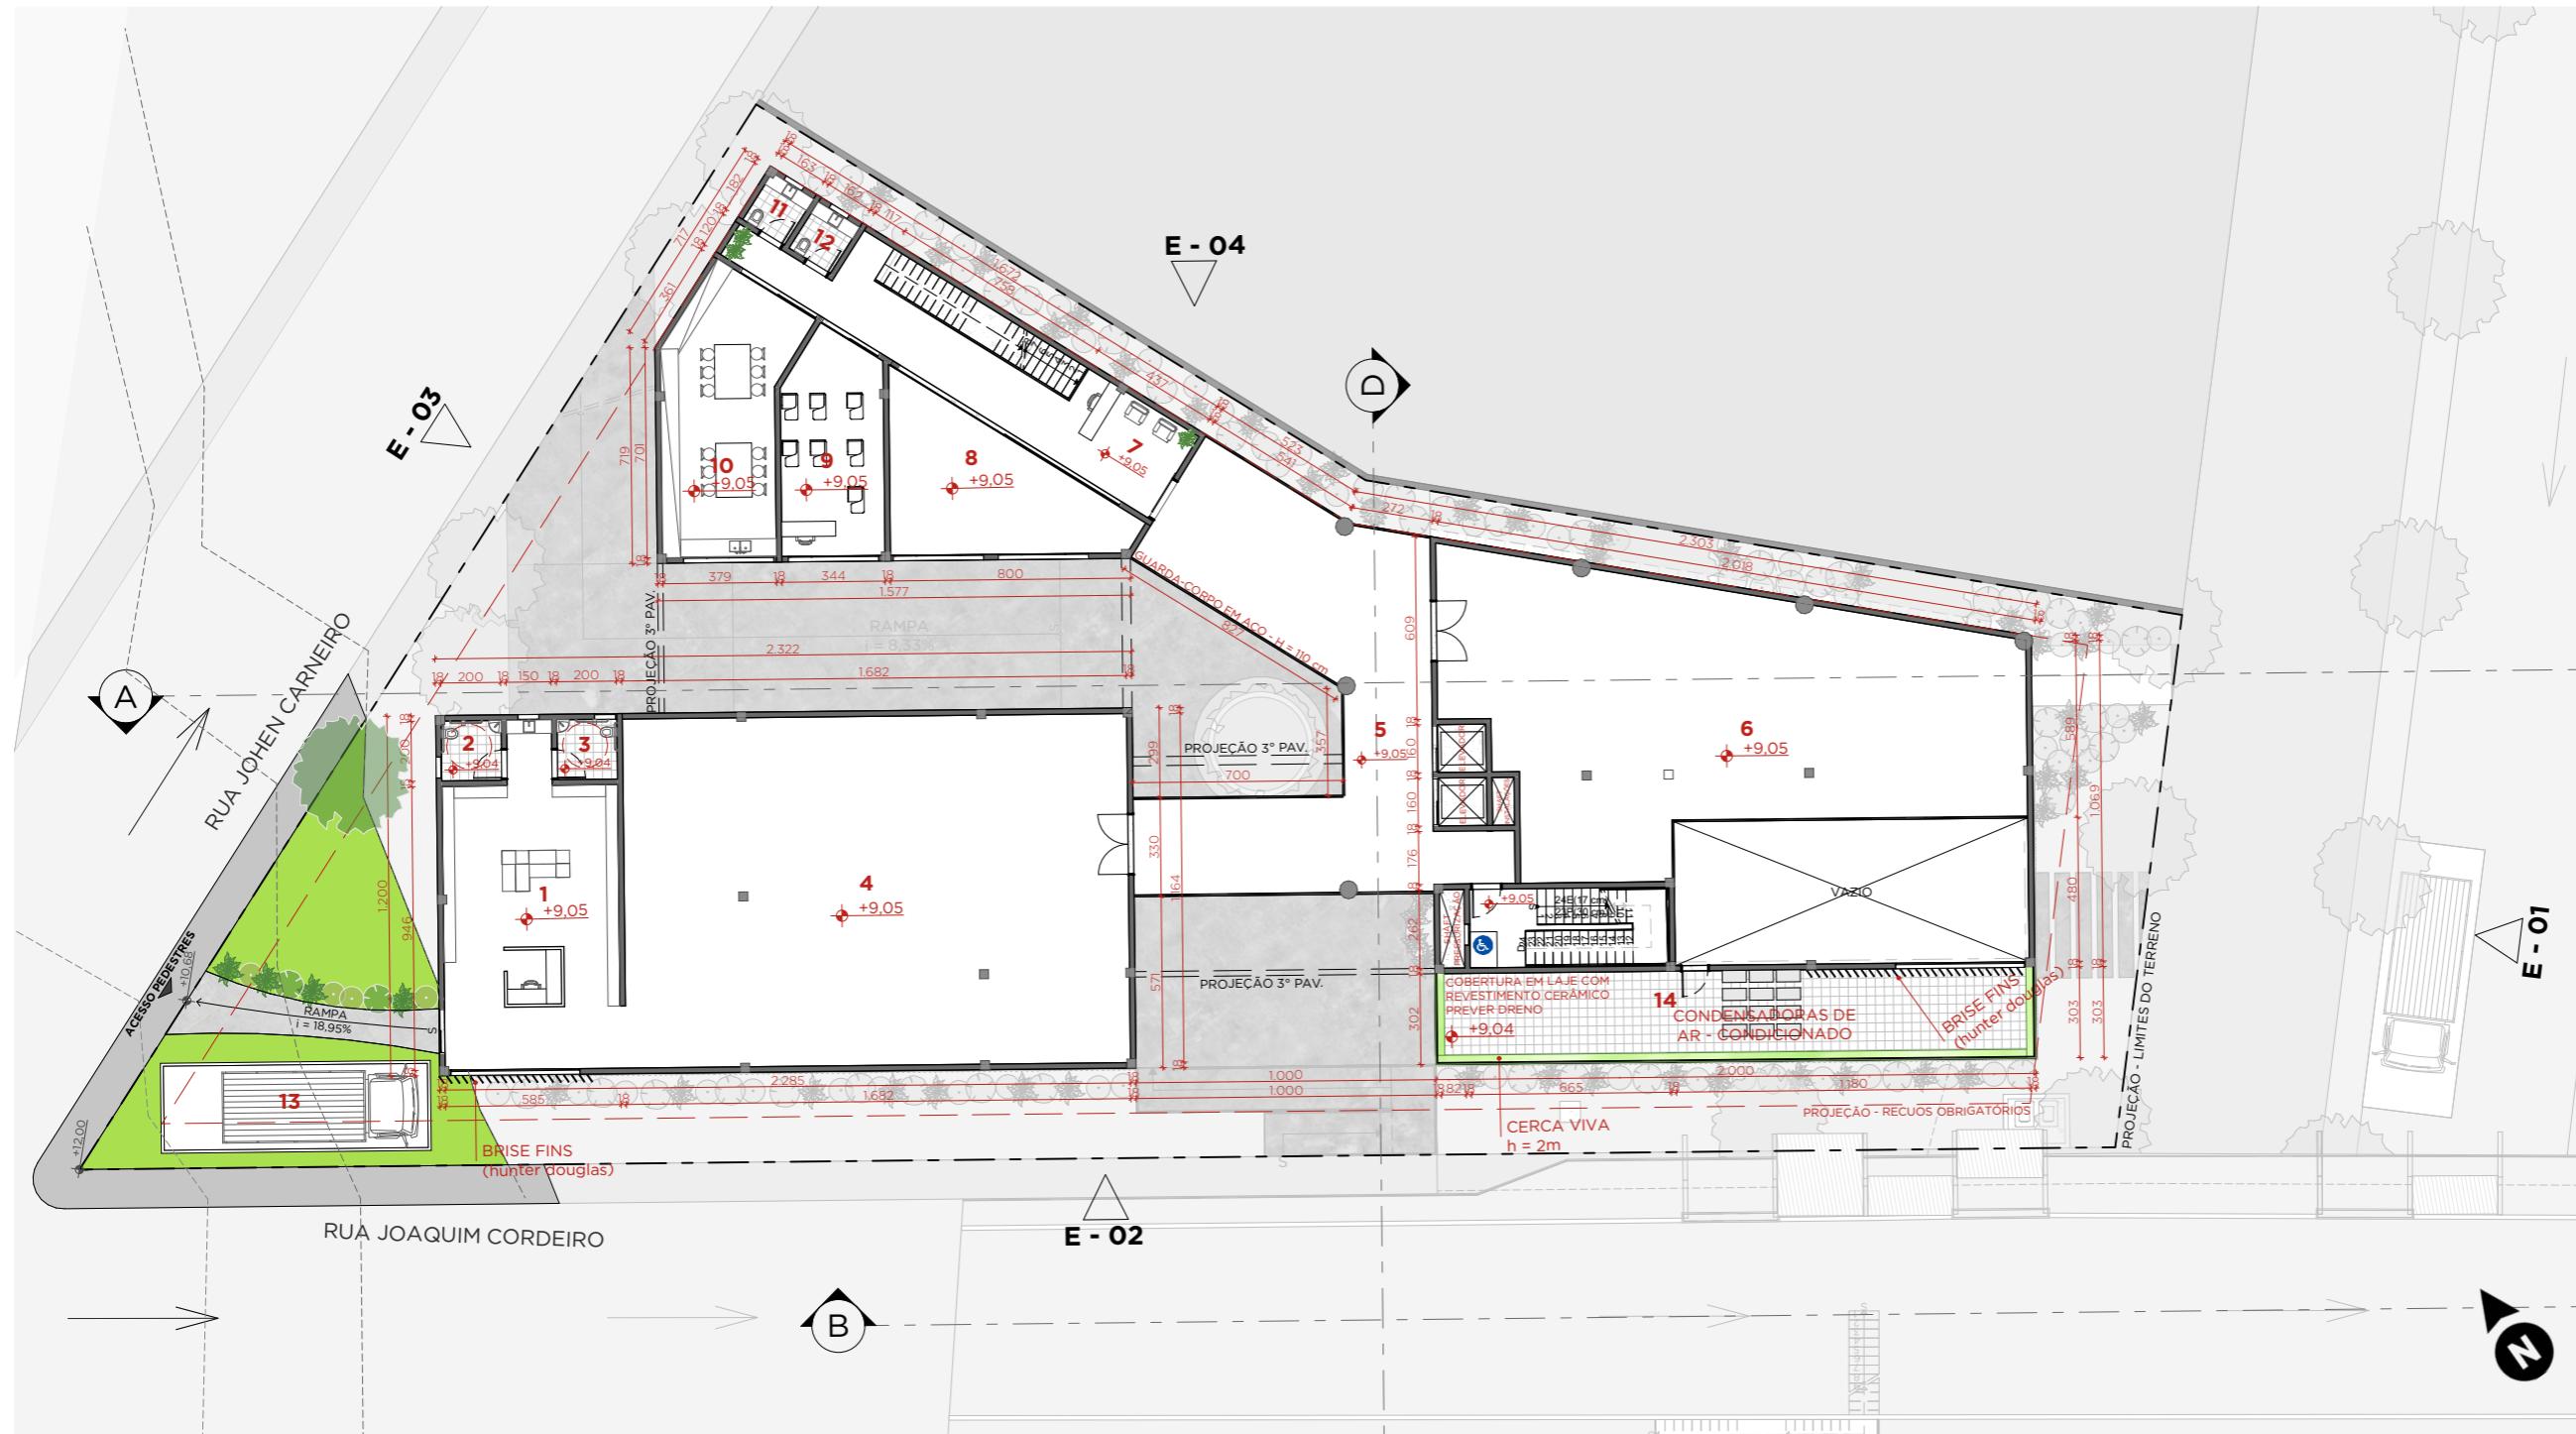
Planta Primeiro Pavimento. Escala: 1:250.
